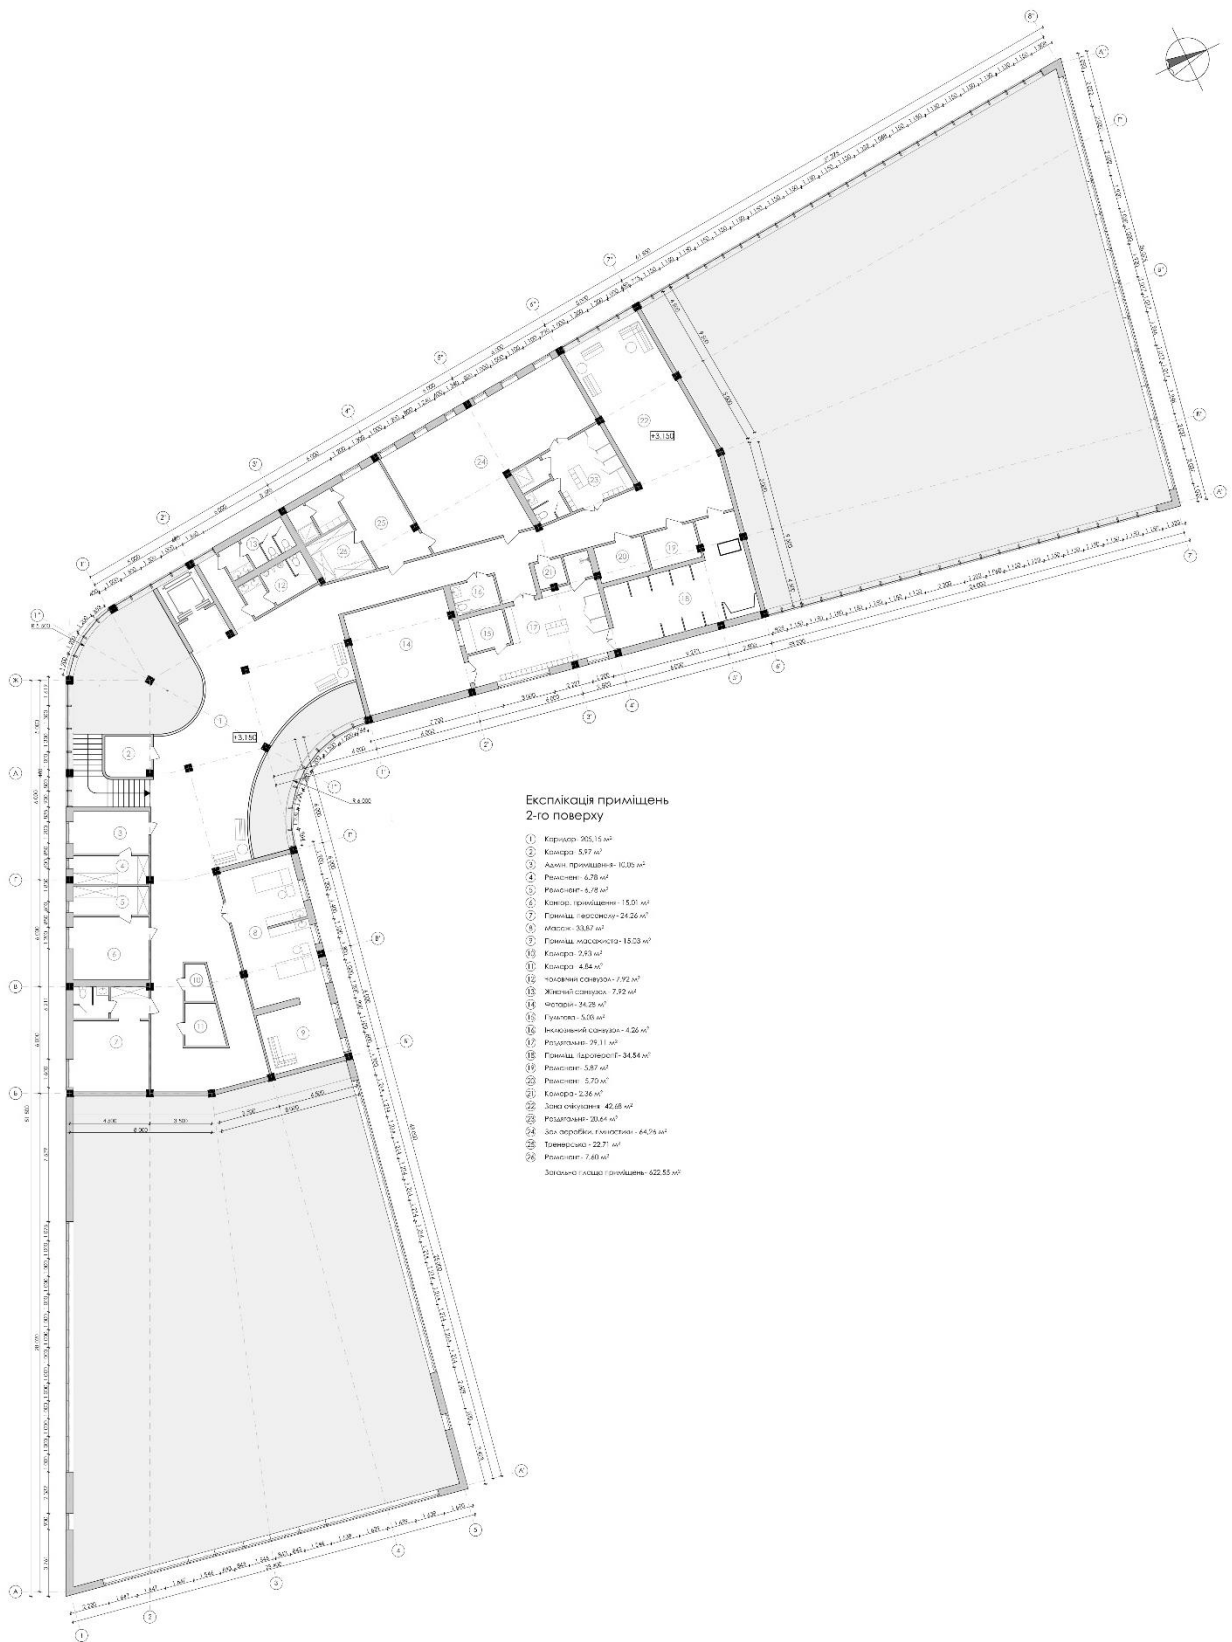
Спортивно-оздоровчий корпус. План другого поверху
